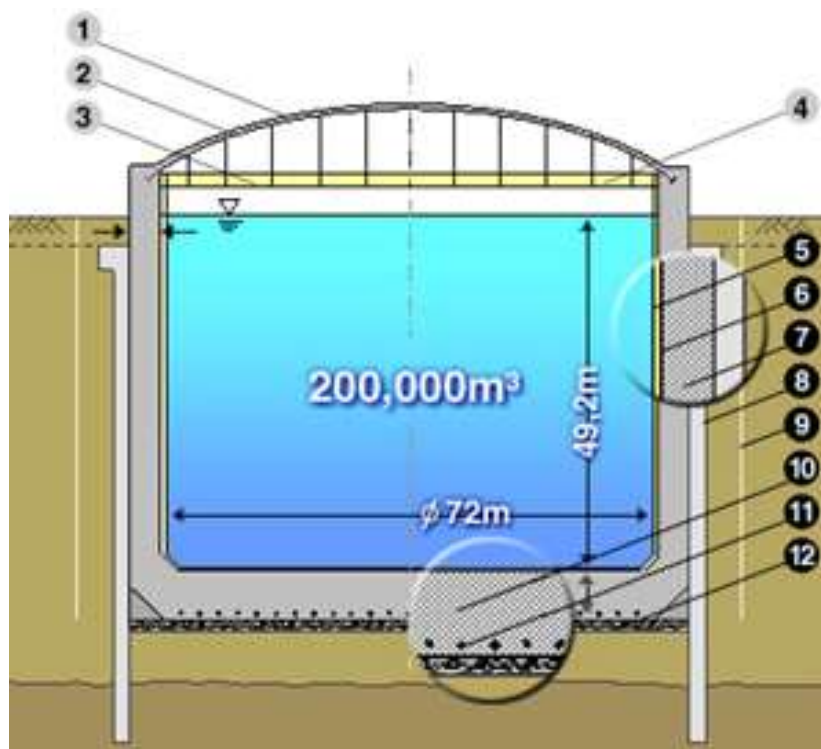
Схема конструкції заглибленого ізотермічного резервуару:
